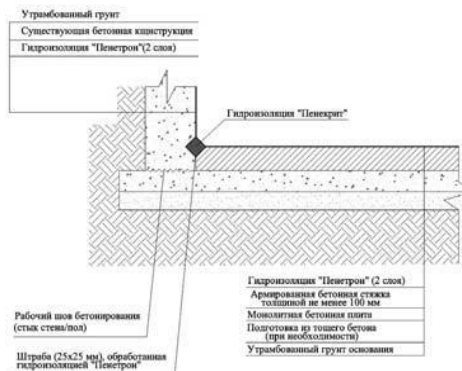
Устройство гидроизоляции из Пенетрона по армированной бетонной стяжке
